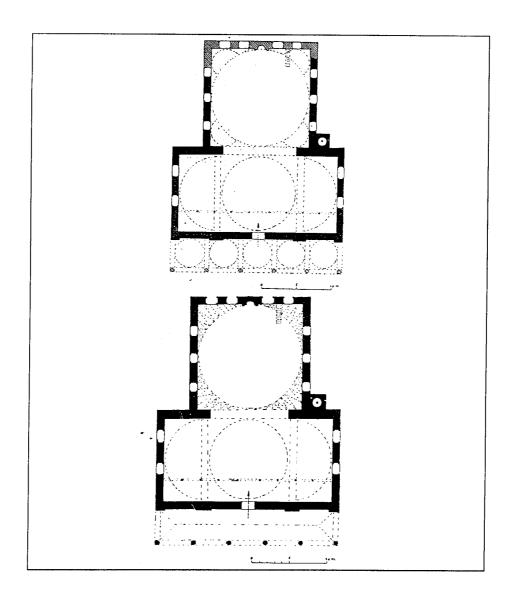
مسقط أفقي لمسجد كيل حسن أغا في روجوفو (عن : كيل) .
